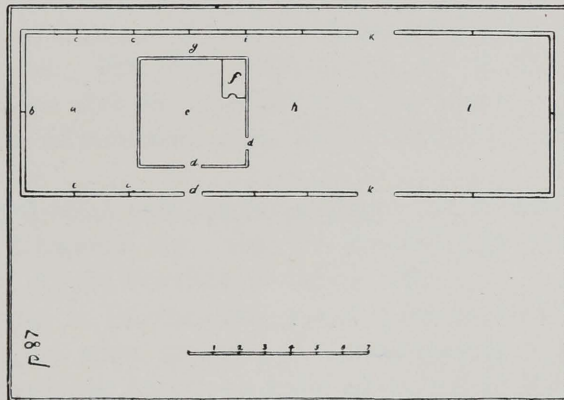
Grundriss eines Dörrhauses. a „Kurzstroh“-Raum. b und c Wände.
